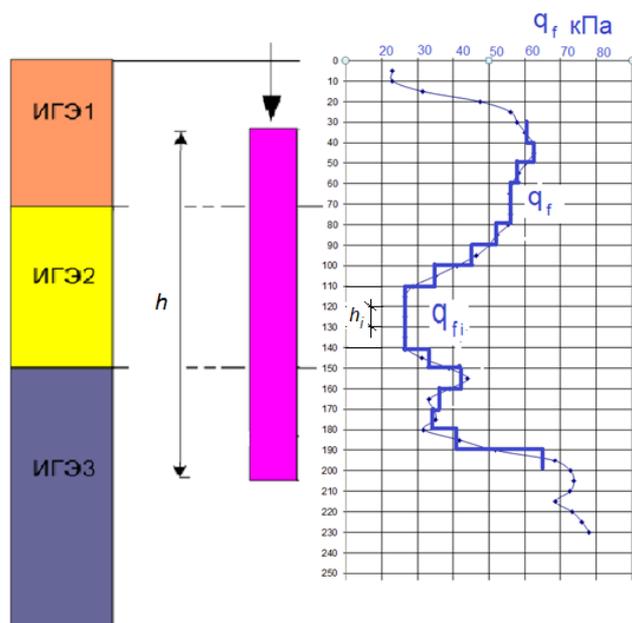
Пример расчетной схемы для определения R_{fs}
